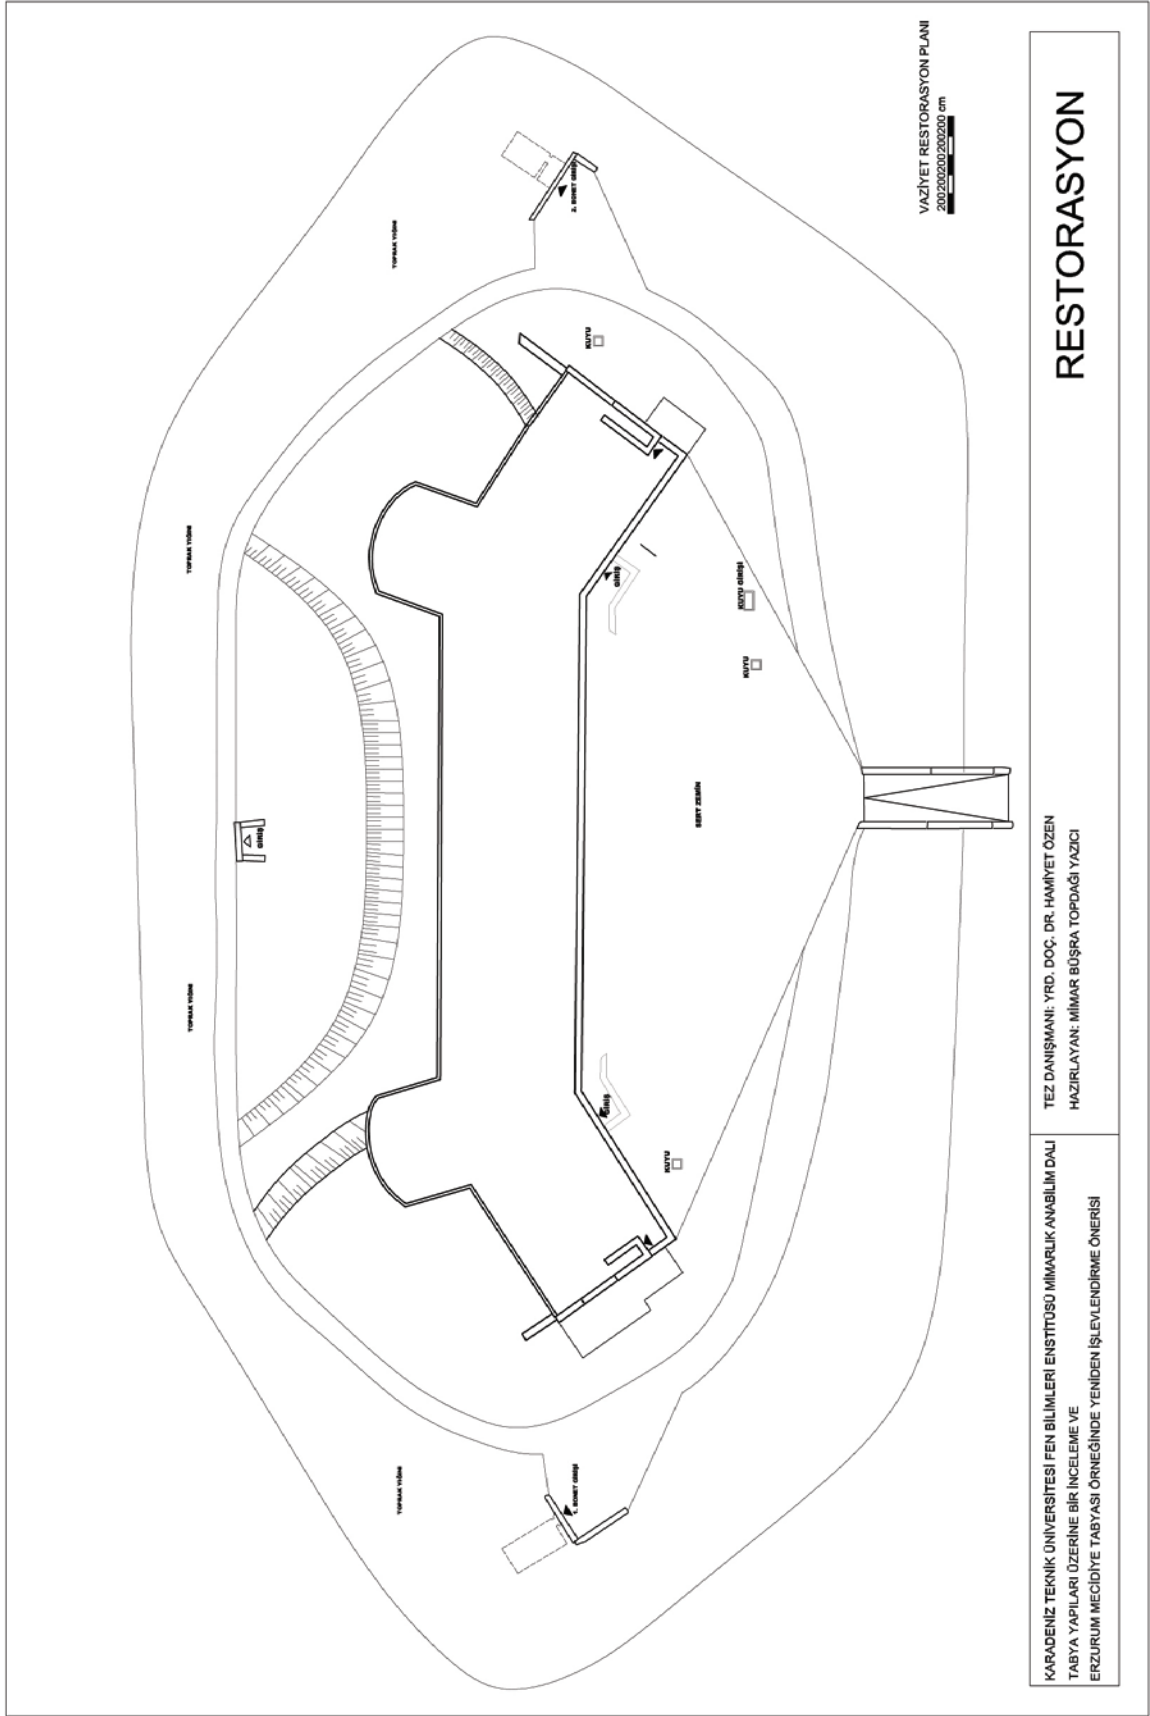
Vaziyet planı ve batı görünüşü müdahale analizleri
